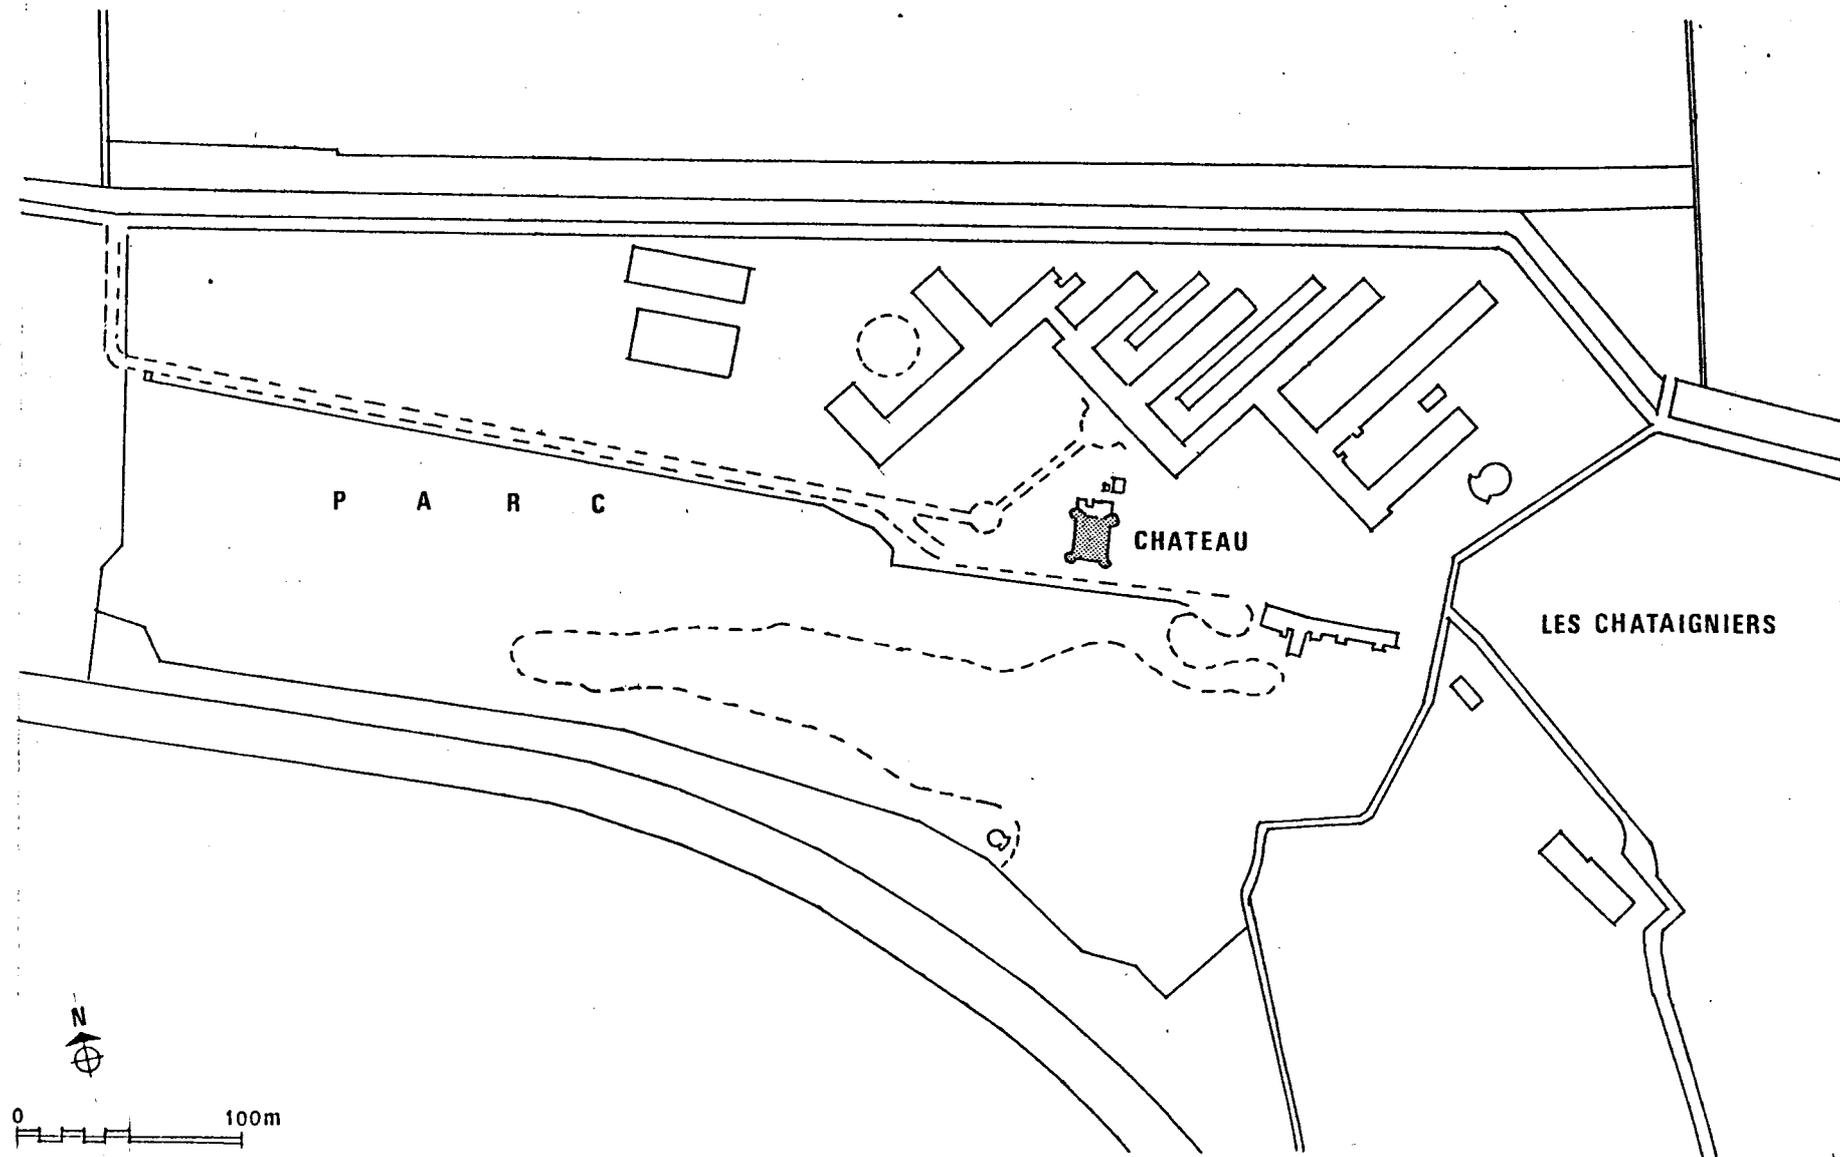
Château de Corbeville. Plan de situation en 1984.
